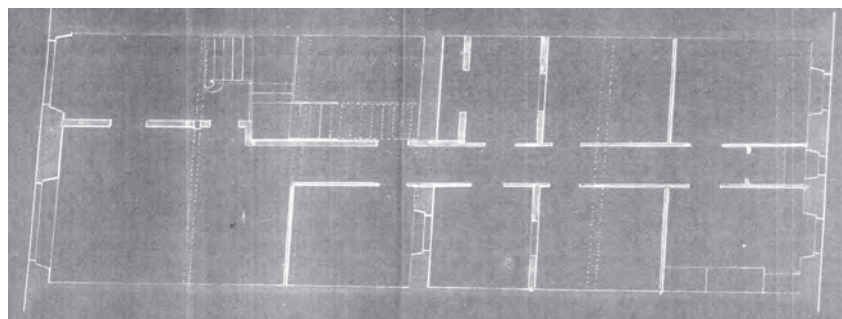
17. 1913 PLANTA BAJA⁴
